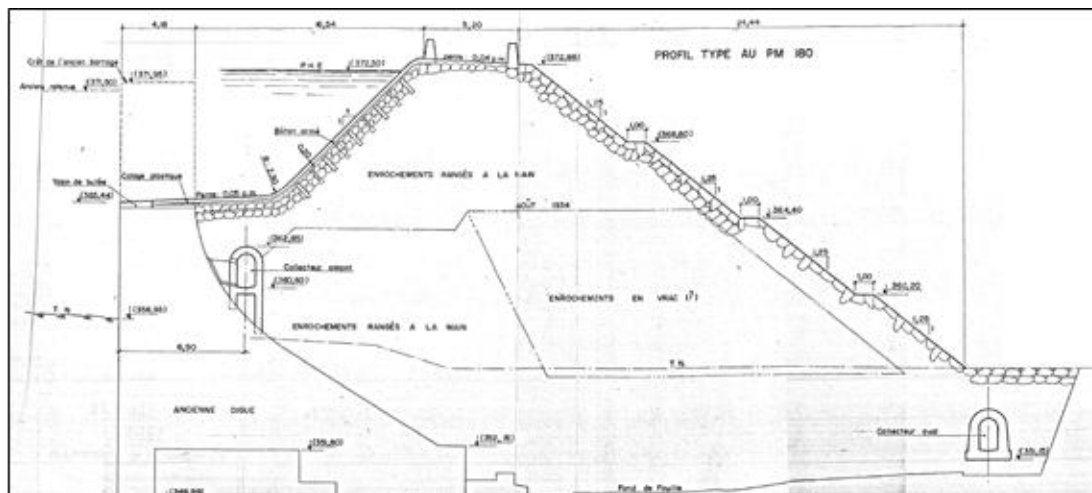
Coupe type amont/aval du barrage montrant la position des galeries de drainage
